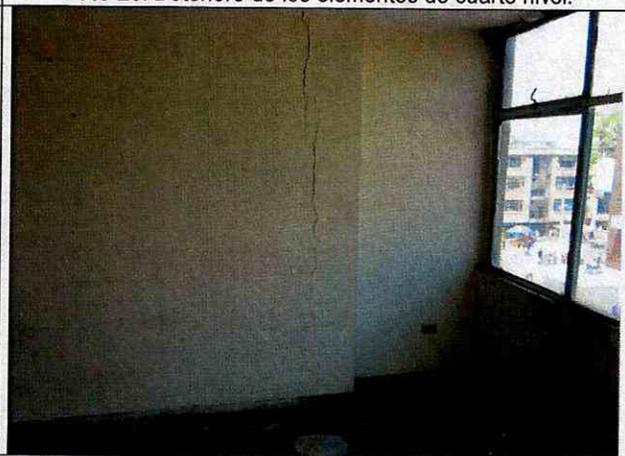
Grieta vertical en muro de cuarto nivel.
